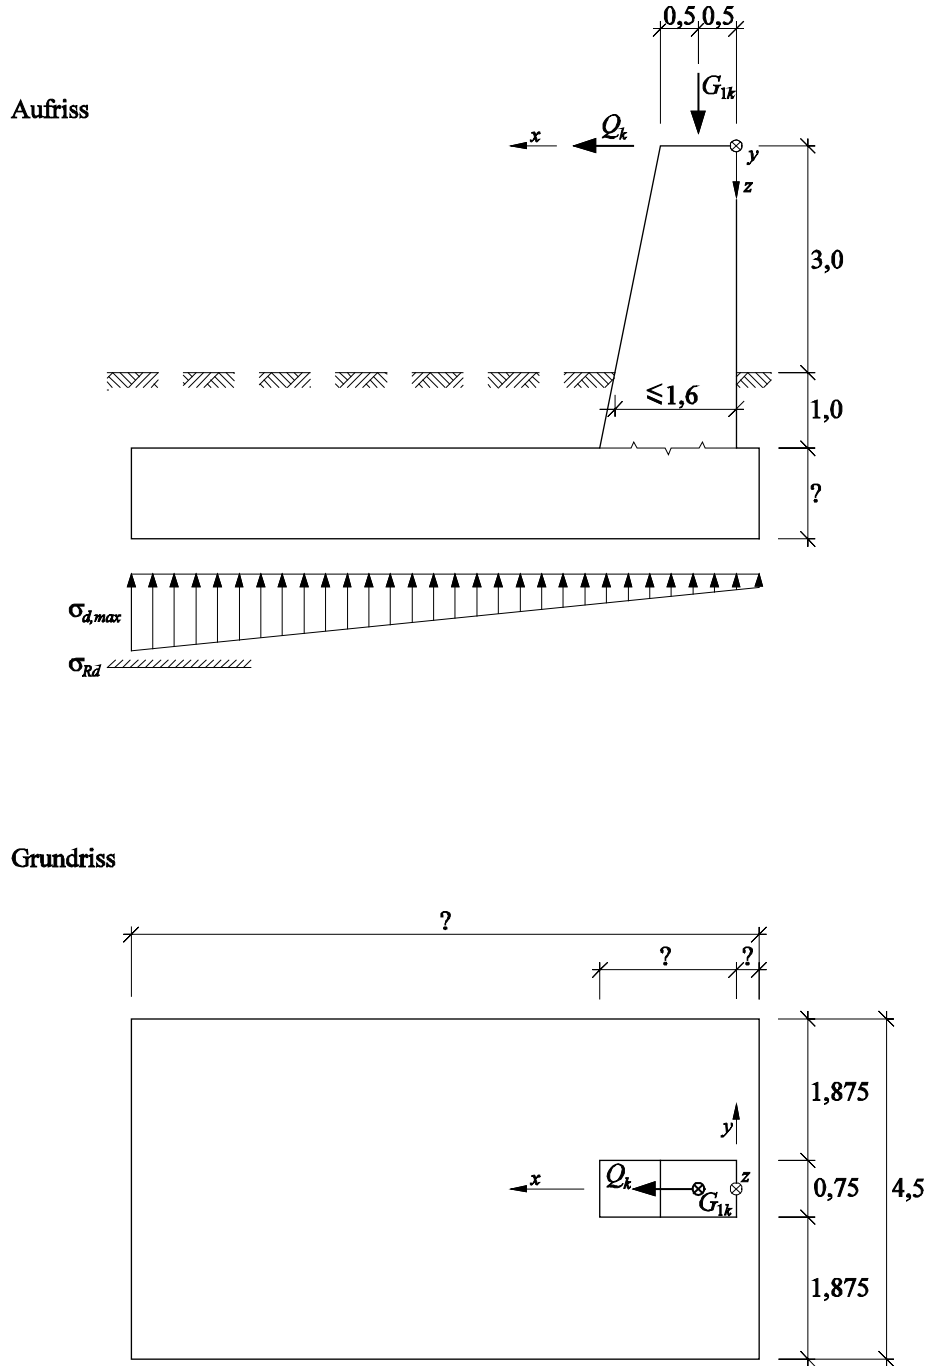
Aufriss und Grundriss der Verankerungskonstruktion. Abmessungen in m.
